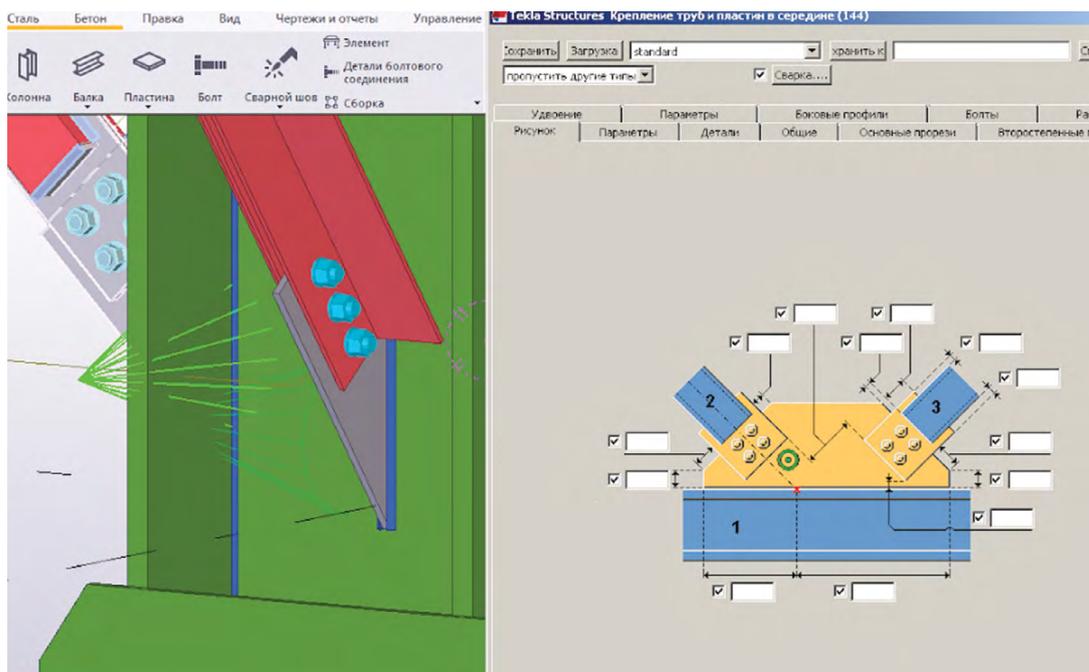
Моделирование узла крепления крестовой связи к колонне
